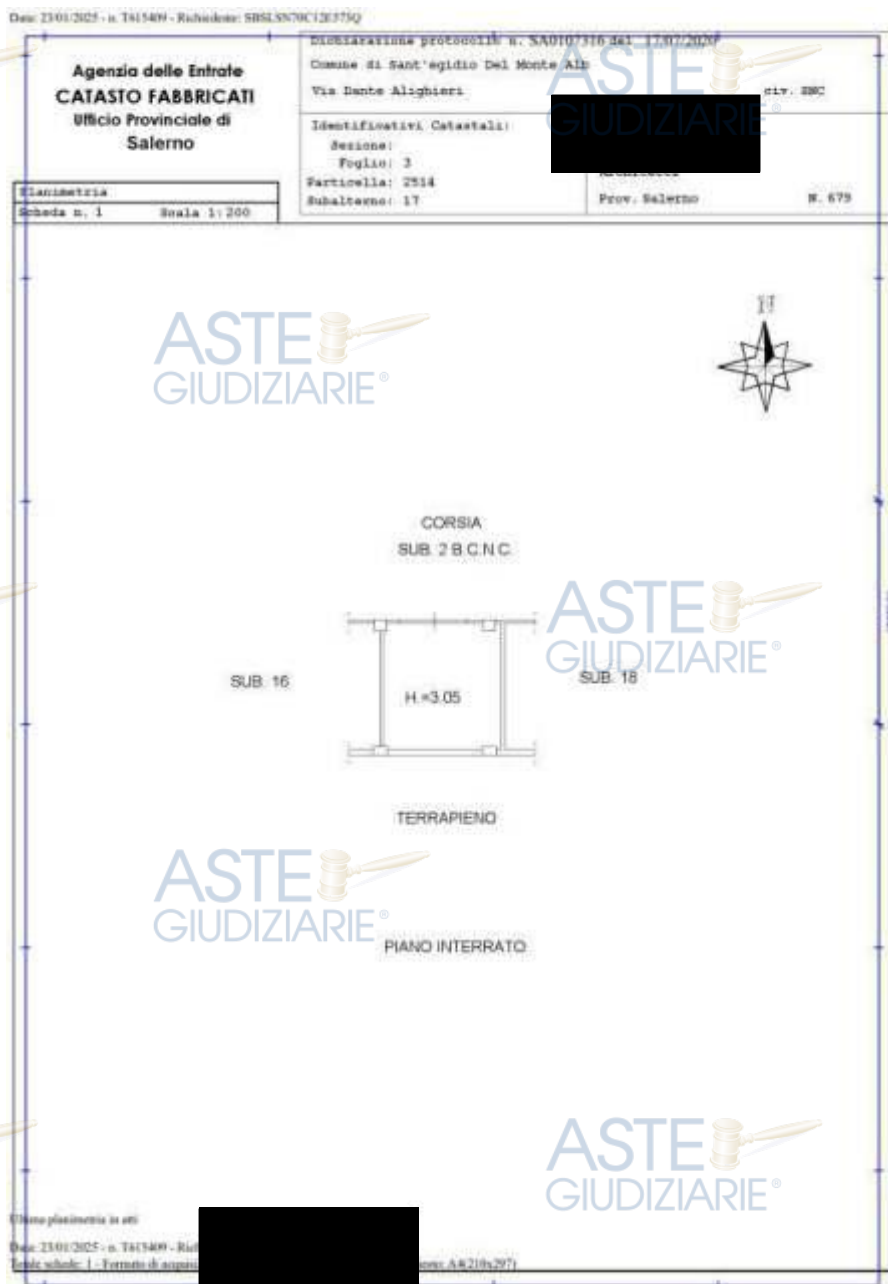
Planimetria catastale compendio pignorato lotto 1
